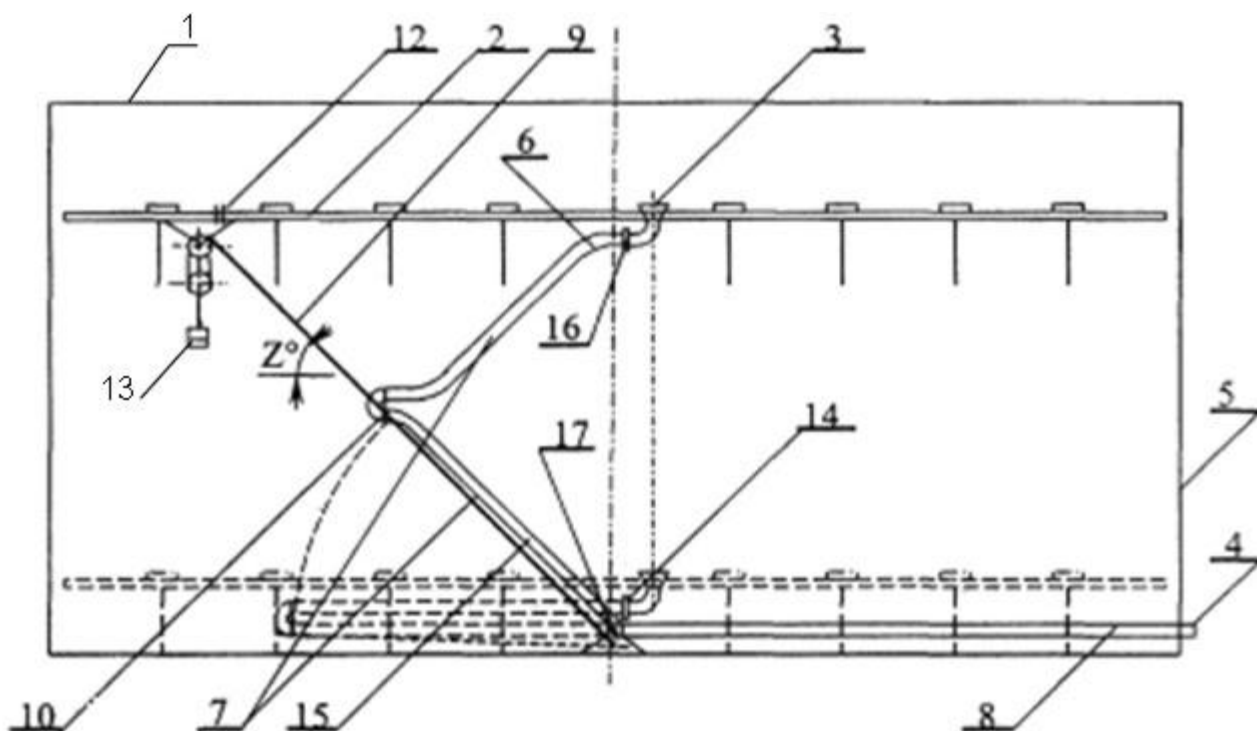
Конструктивные схемы водоспусков с расположением тянущего устройства внутри резервуара
